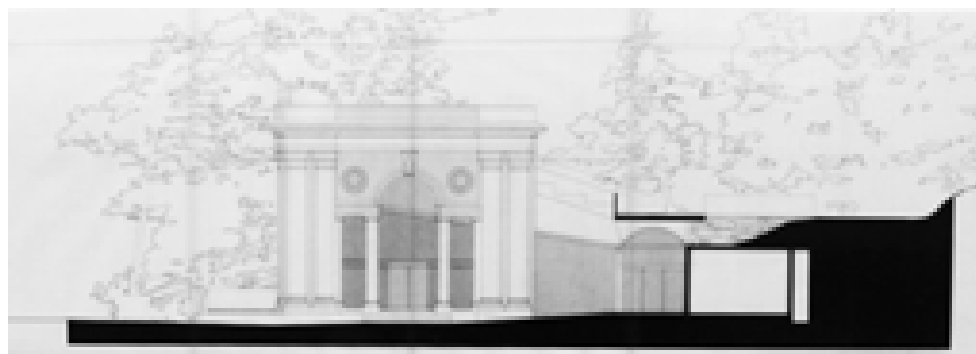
Prospetto Est, stato futuro - Progetto del 15/07/1985, agg. del 15/01/1987 (AABS-154)
